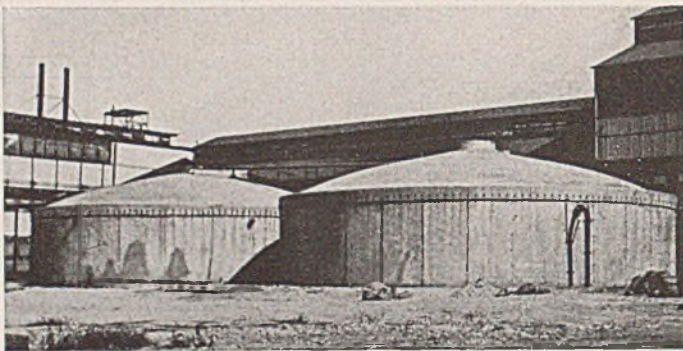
Betonbehälter mit vorgespannten Eiseneinlagen.
